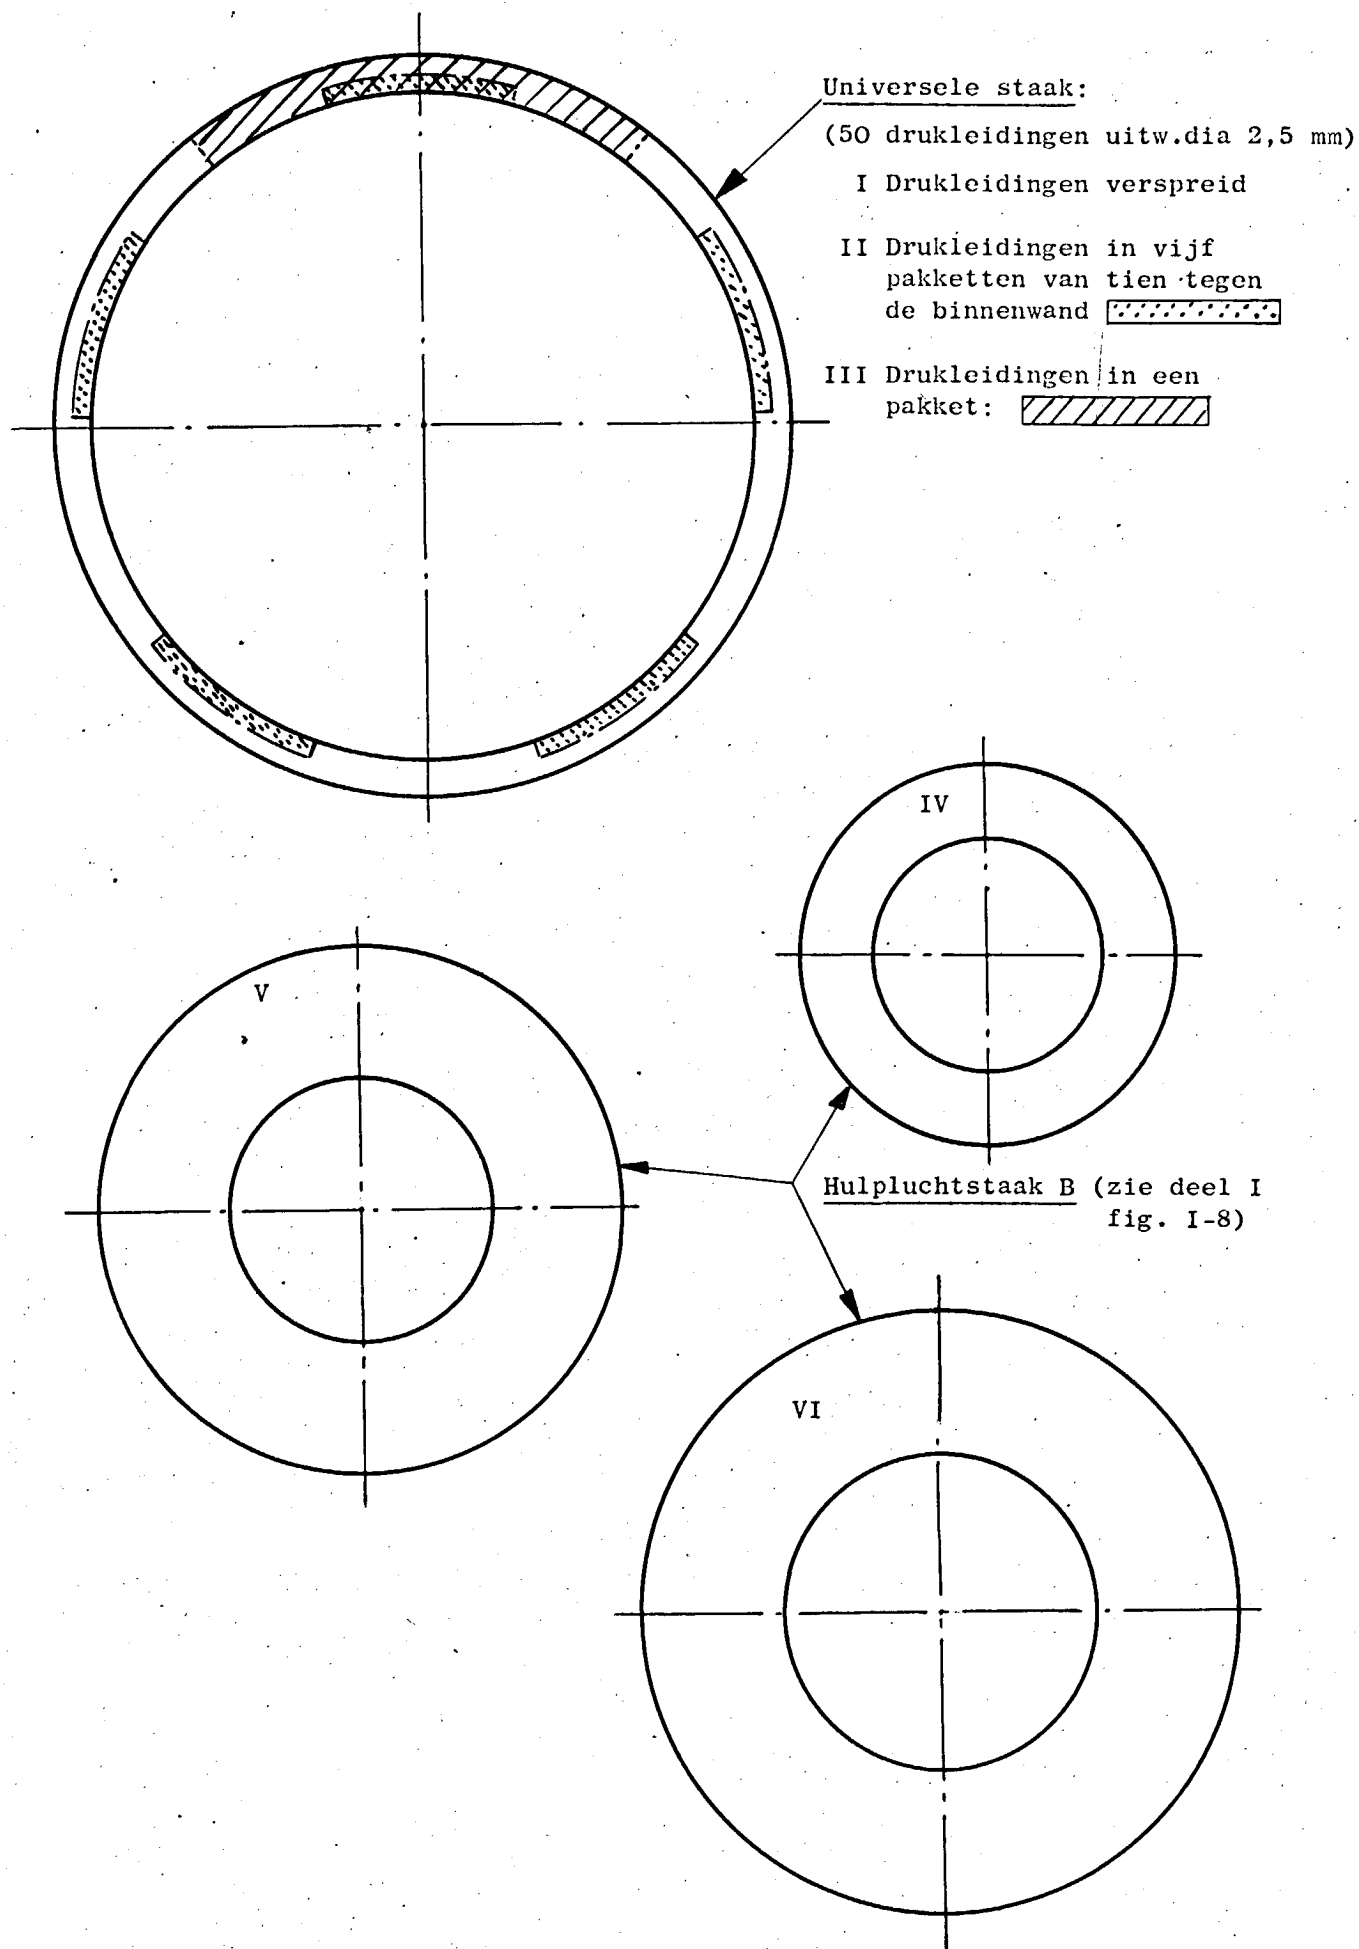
De ringvormige doorsnede van de beschouwde staakleidingen.
